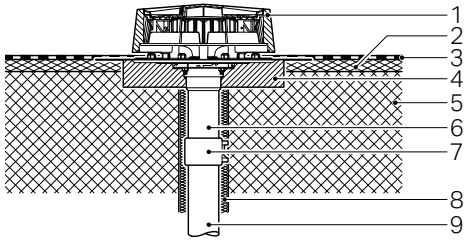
Aufbau Massivdach nicht gedämmt, mit Dachabdichtungsfolie
